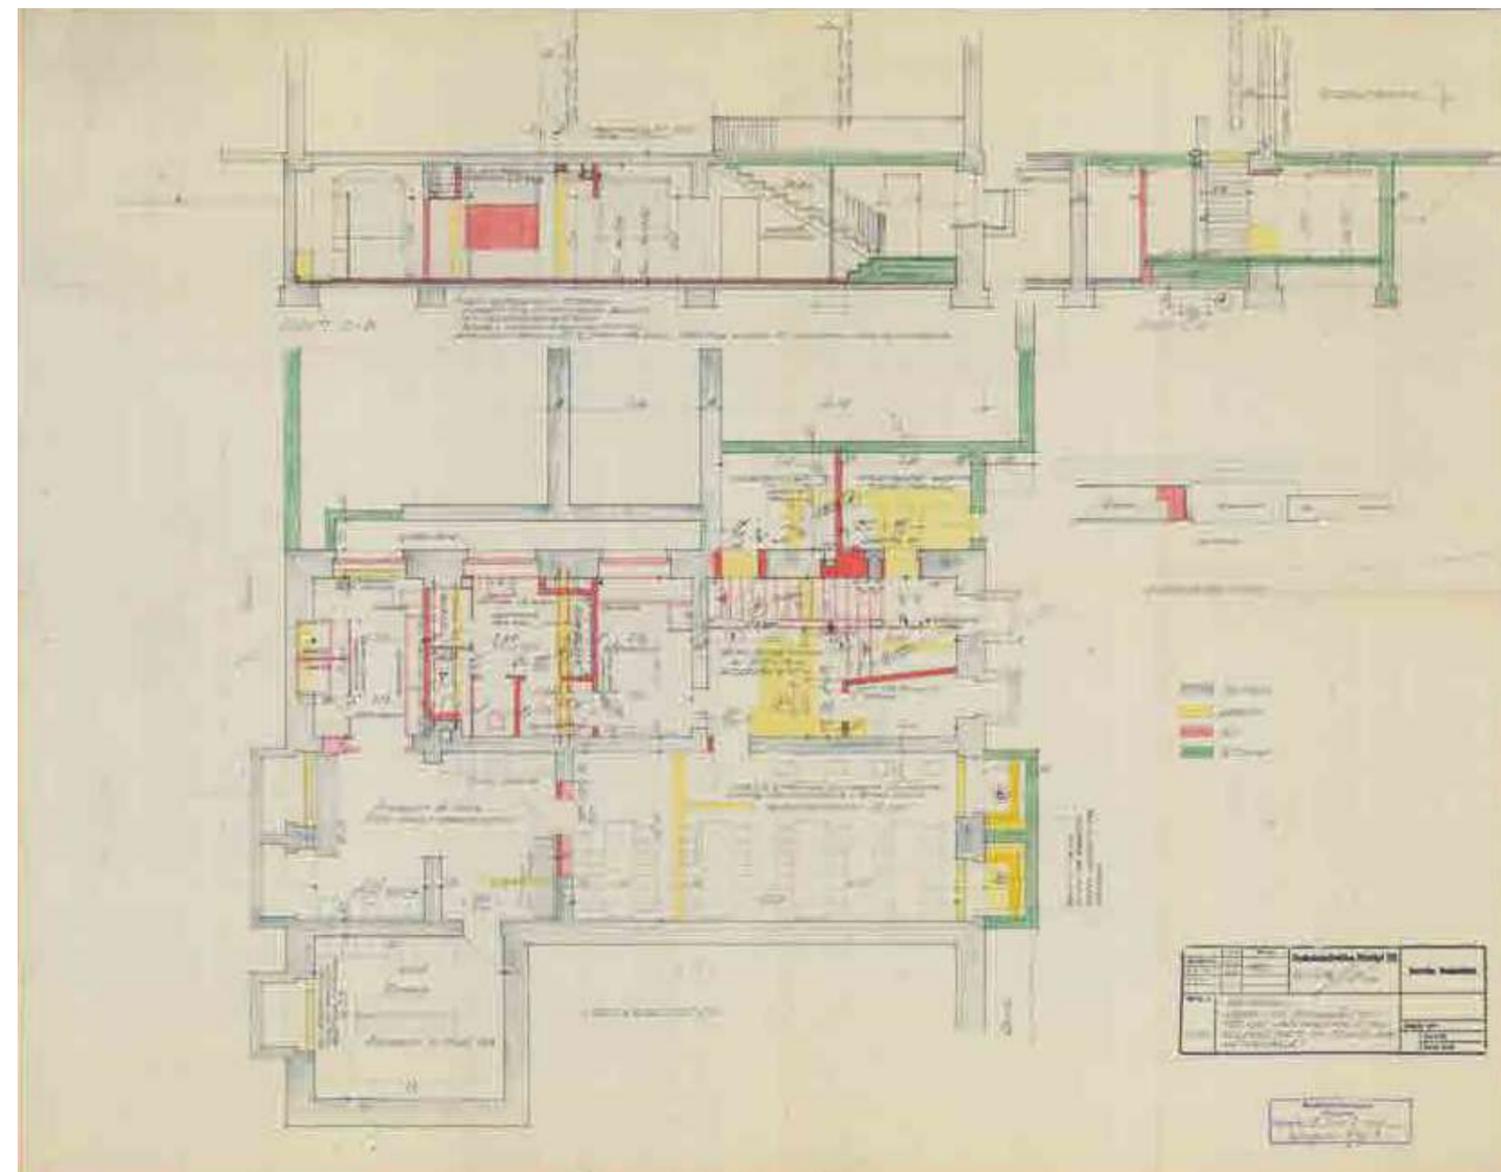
Stückgutschuppen: Plan für den Einbau von Sozialräumen für das Ladepersonal im Kellergeschoss am Südende der Güterhalle, 1969
